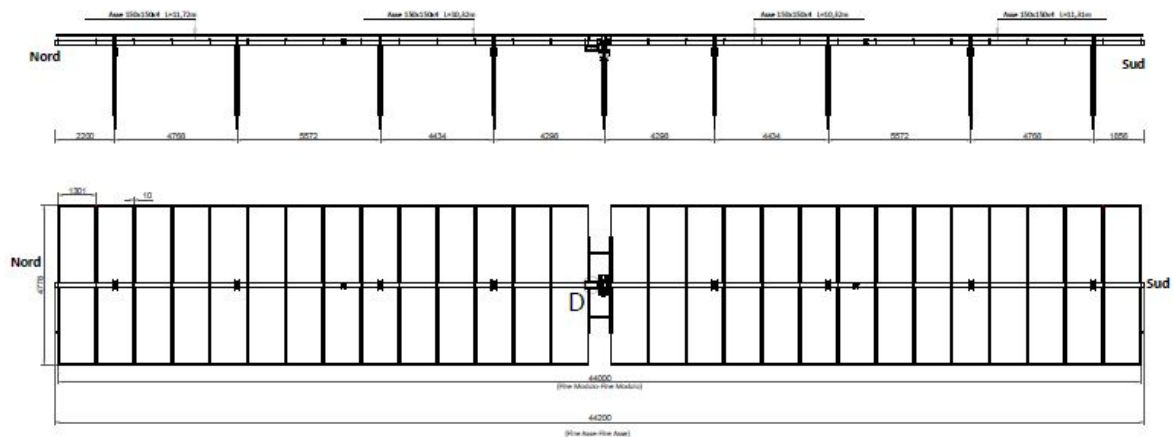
Particolare vista in sezione e in planimetria delle strutture bistringa (28 pannelli)
